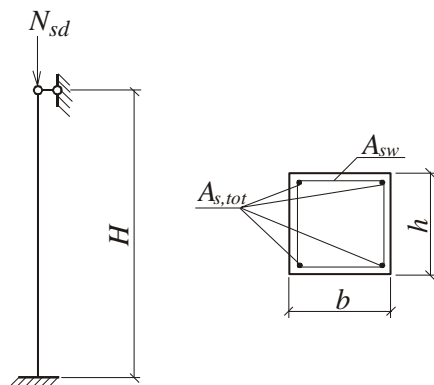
Расчетная схема и поперечное сечение колонны
